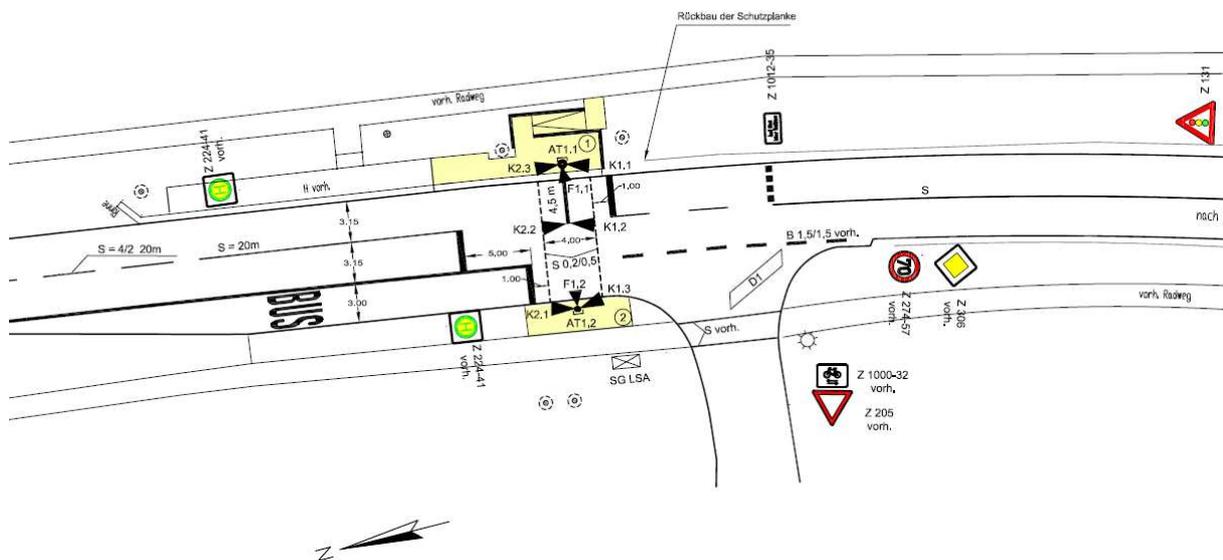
Signallageplan F-LSA <sup>6</sup>
